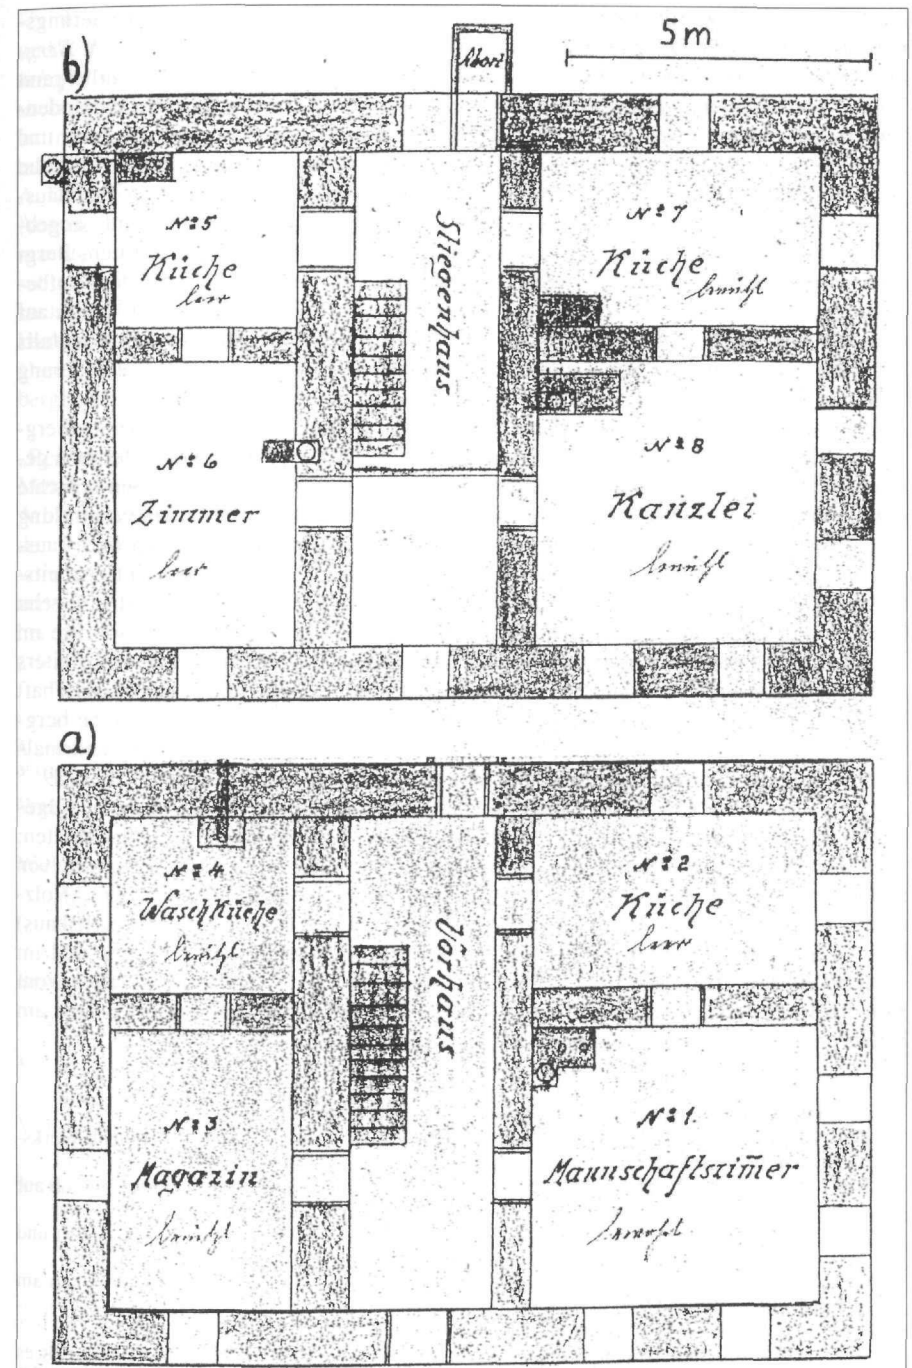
Berghaus in der Walchen (siehe Abb. 8); a) Erdgeschoß, b) Obergeschoß. Ausschnitt aus dem Plan „Berghaus Walchen Nr. 165; Öblarn, am 29. I. 1939“ von P. Kupferer (Sammlung „Bergbau Walchen“ der Familie Schrögnauer, Öblarn).
